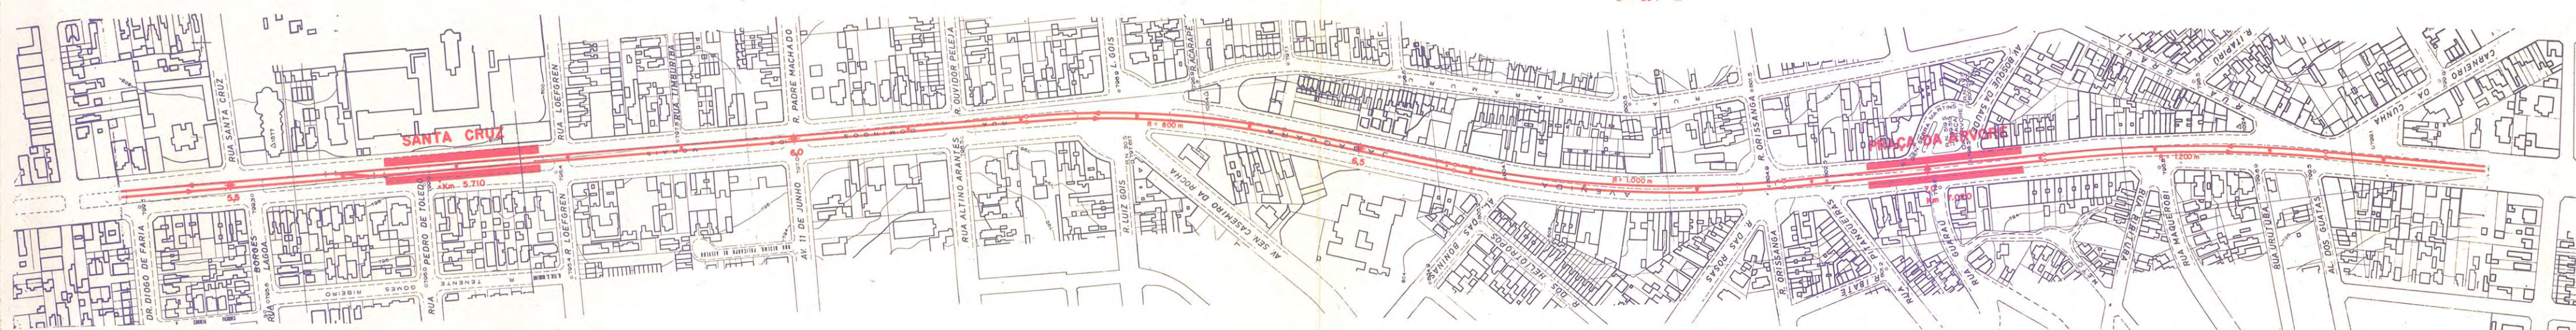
/V Traçado da Linha Santana-Jabaquara, com ramal Paraiso-Moema; perfil longitudinal e planta
